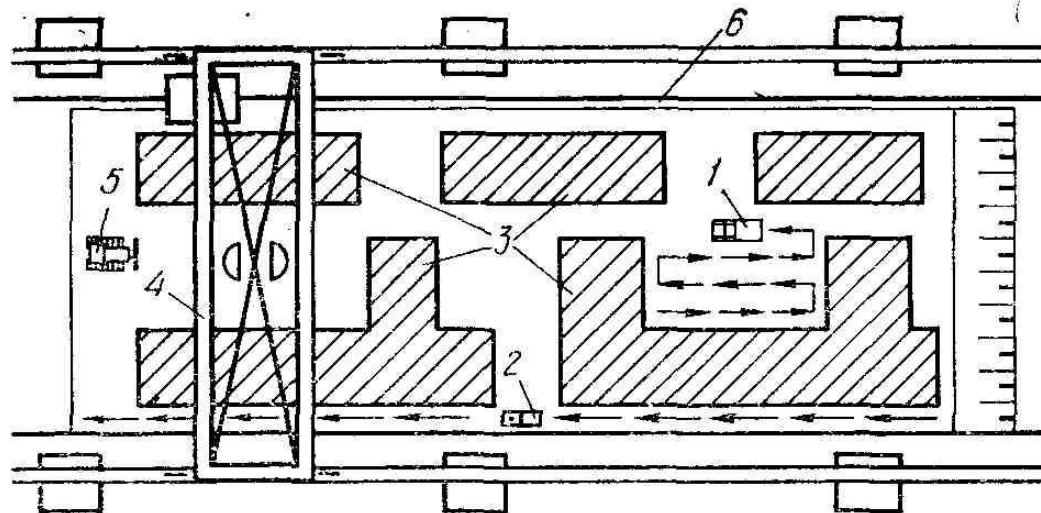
Схема обратной засыпки и уплотнения грунта между фундаментами внутри цеха:
